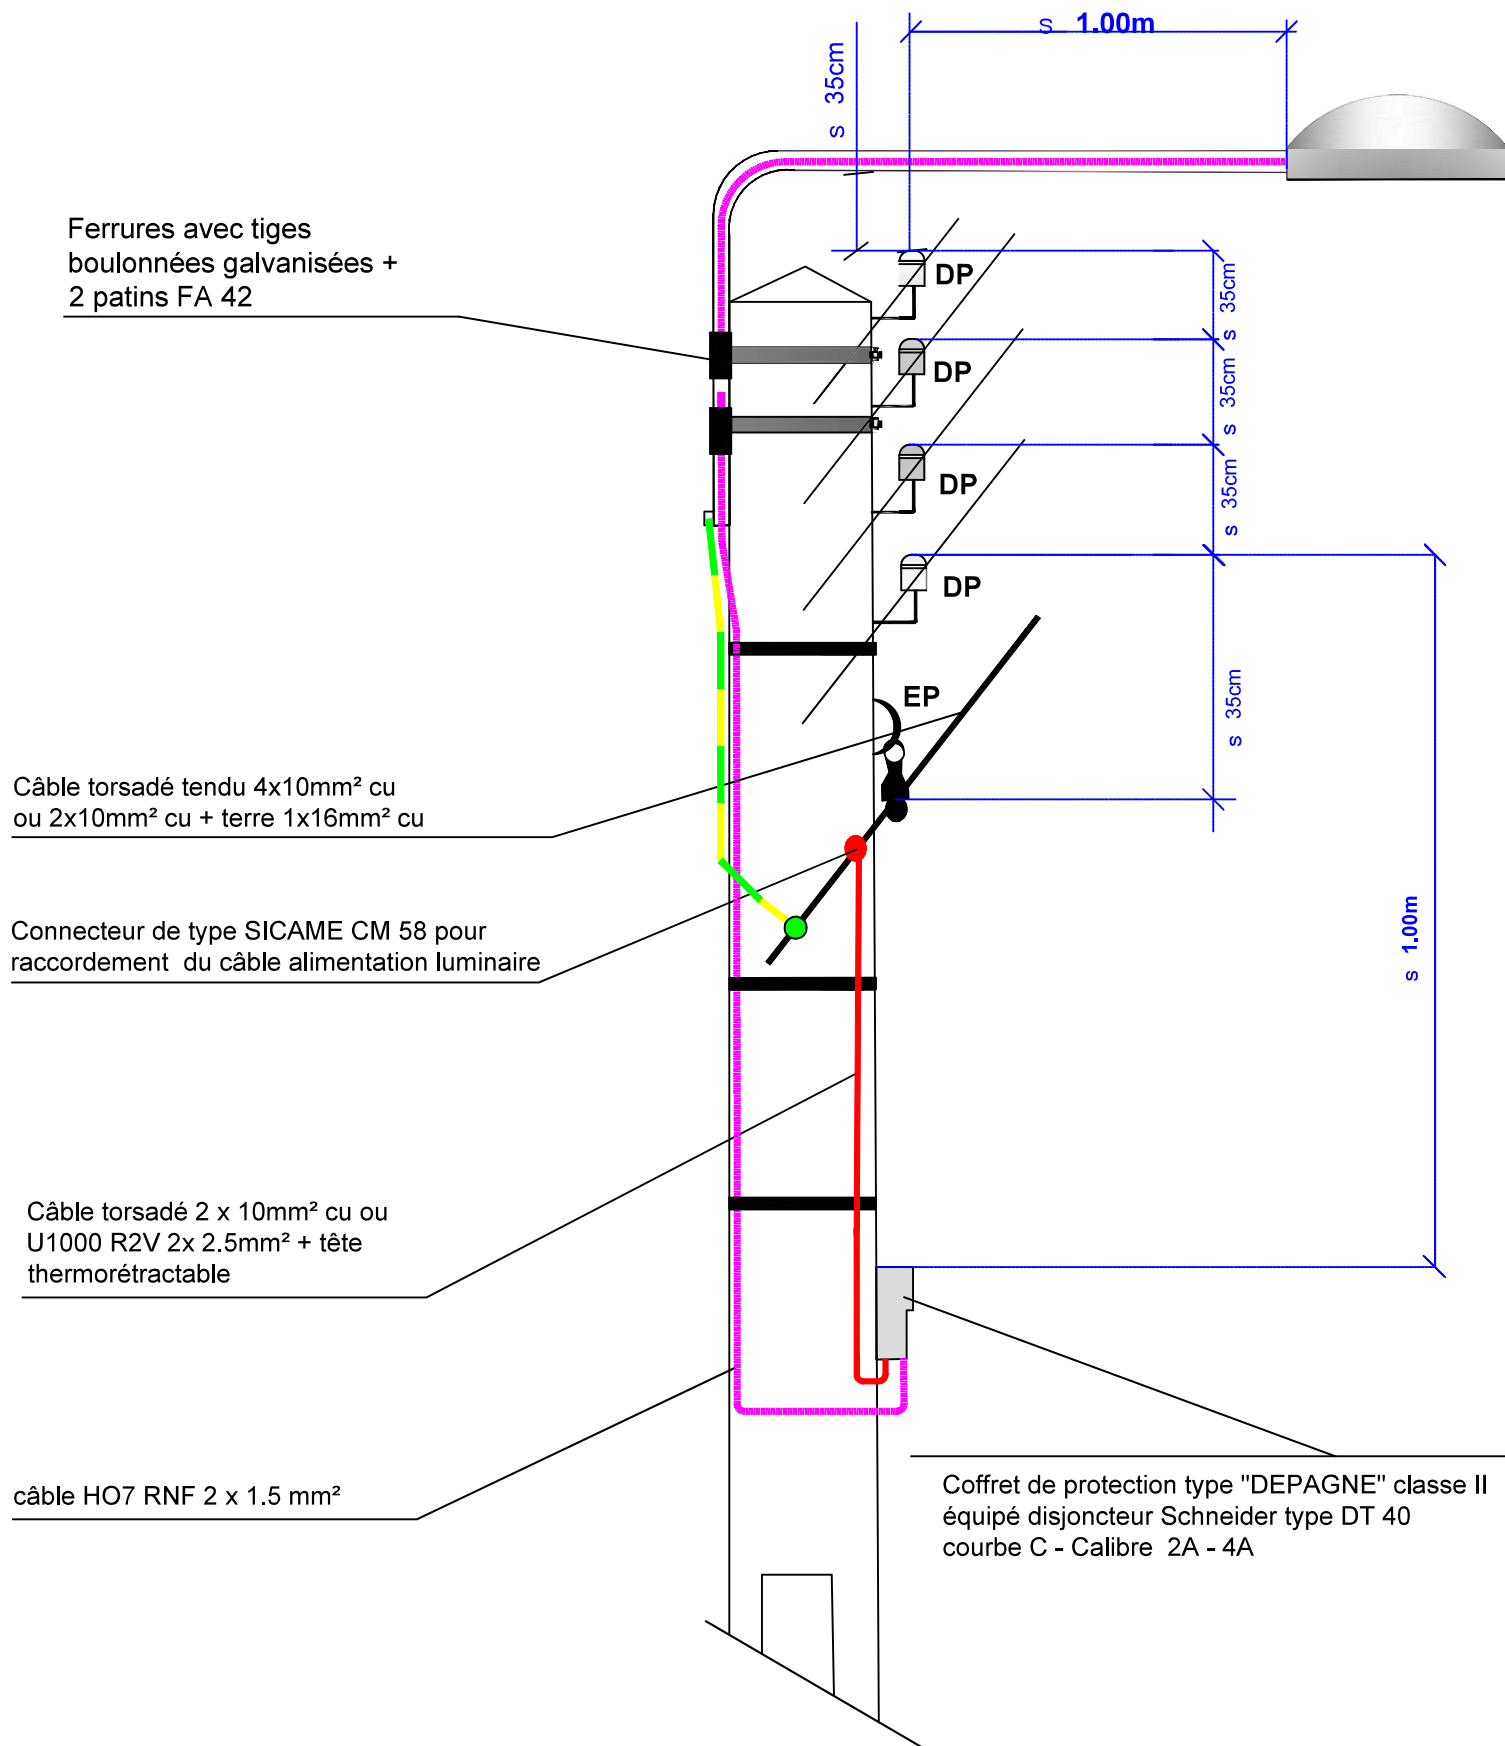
DETAIL: Principe de pose d'un luminaire sur support mixte DP/EP - Torsadé/Torsadé.
